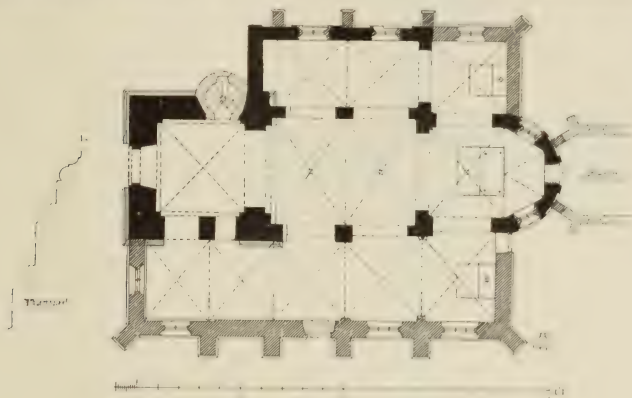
Esch. Grundriss der Pfarrkirche.
